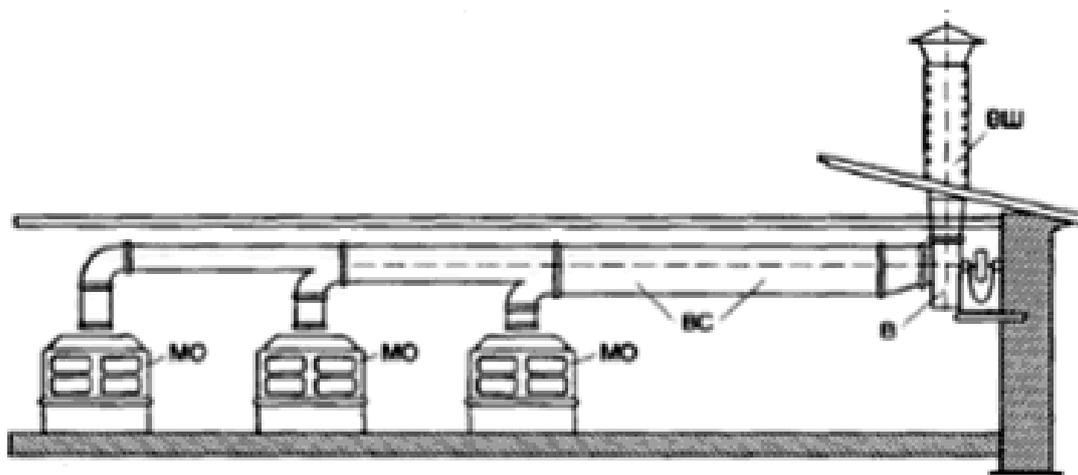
Схема местной вытяжной вентиляции: МО – местные отсосы, ВС – вытяжные каналы, В – вентилятор, ВШ – вытяжная шахта
